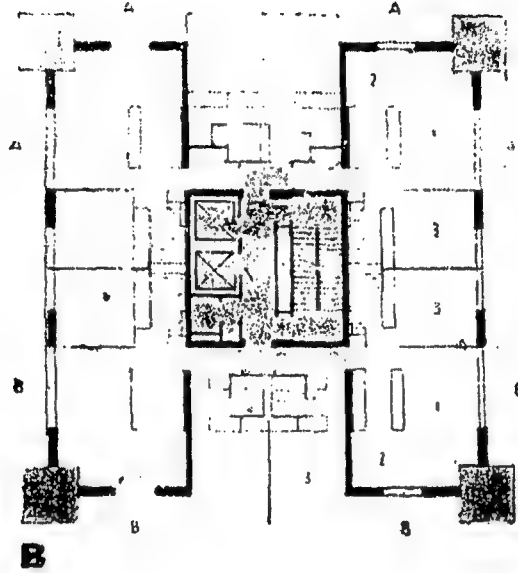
٤ - ٣: مسقط أفقي للدور المتكرر في البرج ، أسفل - مسقط أفقي .
